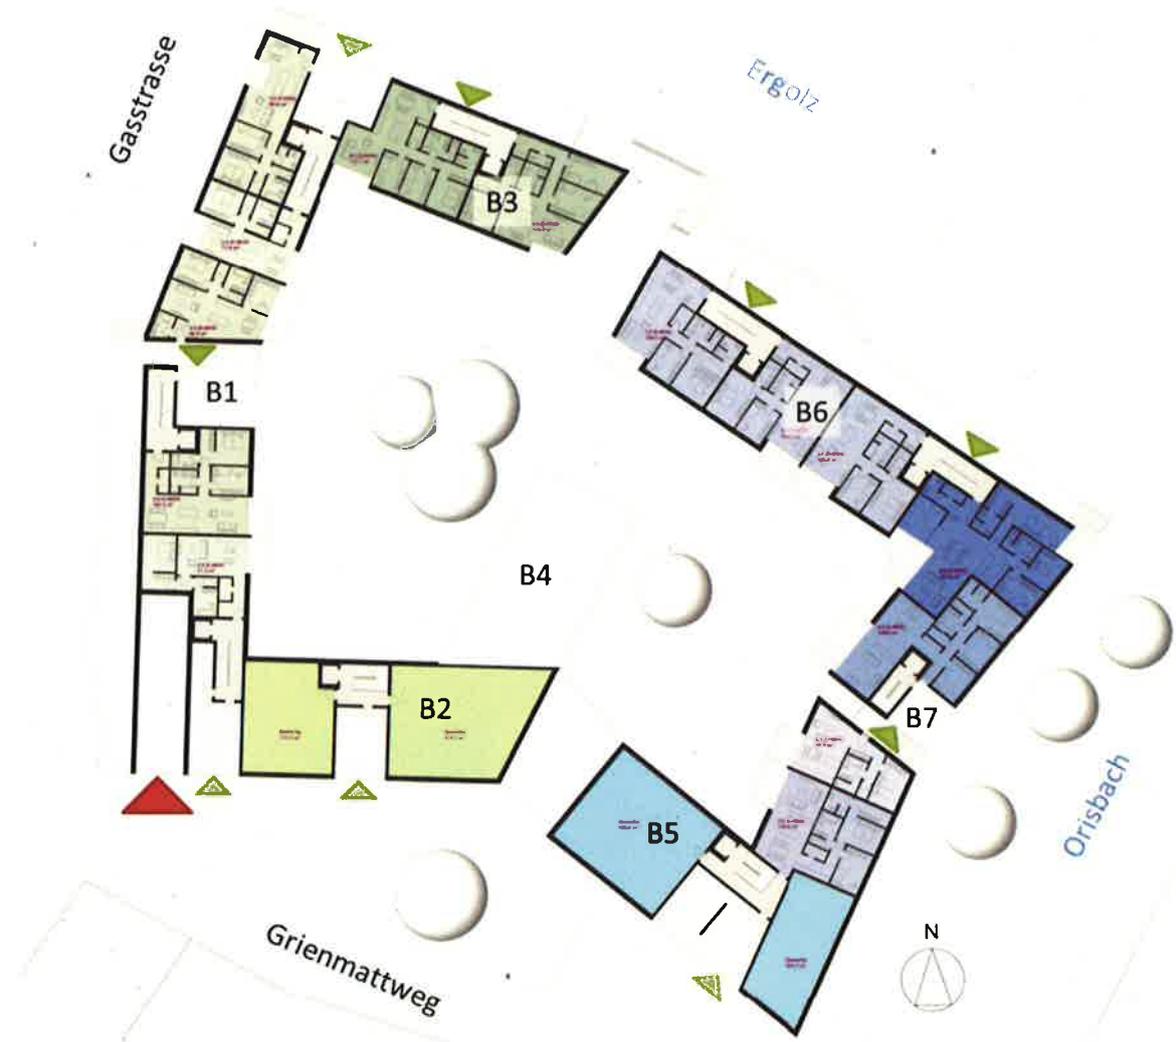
Situation Wohnüberbauung Aurisa [1] mit Zufahrt zur Einstellhalle (rot) und den vorgesehenen Zugängen zu den Gebäuden (grün)
